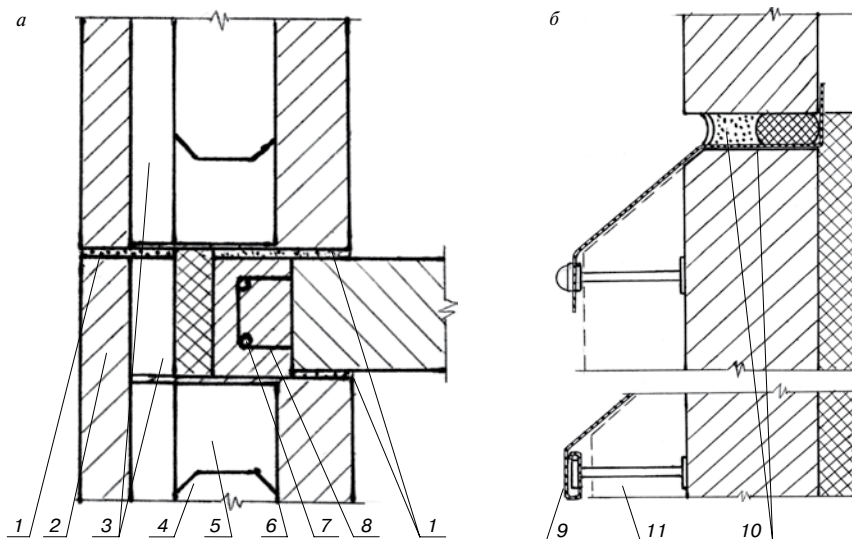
Вариант исполнения горизонтального стыка между панелями цокольного и 1-го этажей с наружным и внутренним несущими слоями (а). Навесной фасад условно не показан: 1 – растворные швы; 2 – наружный несущий слой; 3 – ребра; 4 – утеплитель; 5 – связь; 6 – внутренний несущий слой; 7 – непрерывная продольная арматура в бетоне железобетонного пояса; 8 – петлевые выпуски. Фрагмент стыка между несущим слоем панели 1-го этажа с наружным ограждающим слоем рядовой наружной панели 2-го этажа с внутренним несущим слоем при наличии навесного фасада (б): 9 – фартук; 10 – герметизирующая мастика; 11 – навесной фасад (показан условно)
